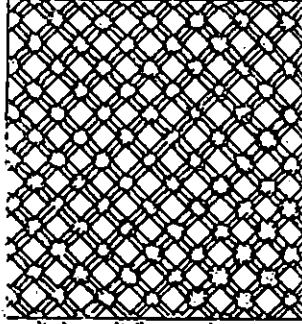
مسقط أفقي لقبة سيدي حمزة الققيه .
